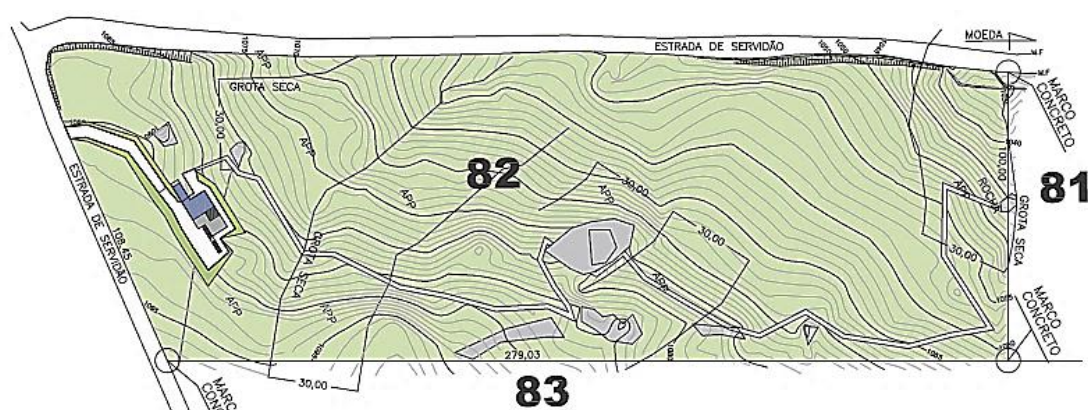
Planta de implantação produzida pelo arquiteto 2
